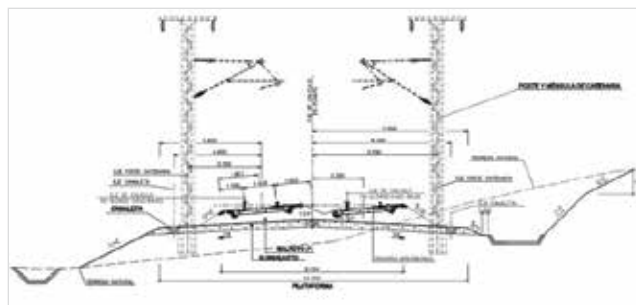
Sección tipo: LAV Madrid-Extremadura.
